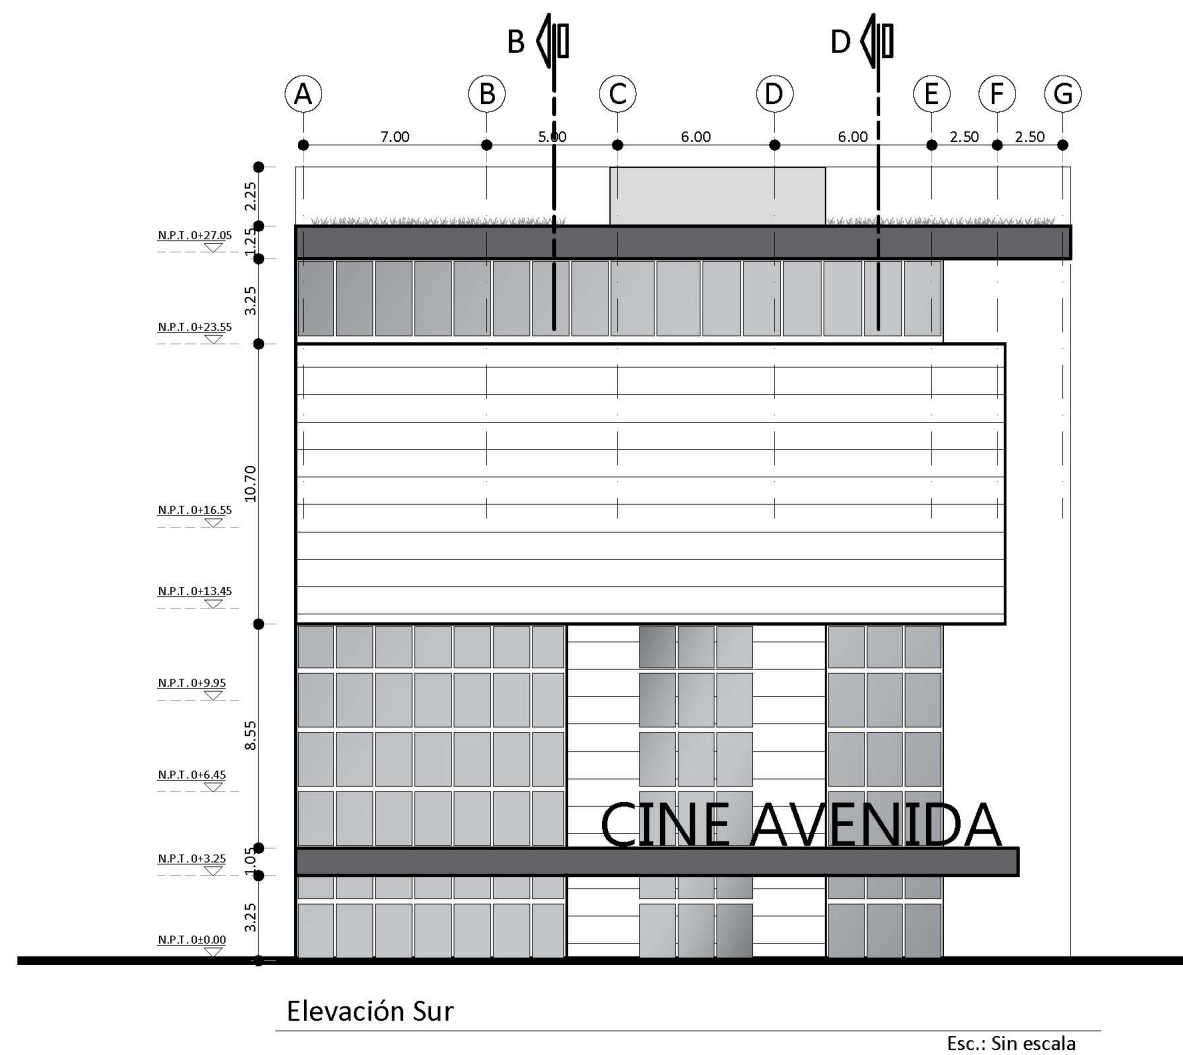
Detalle arquitectónico de elevación sur. Fuente: Propia.
